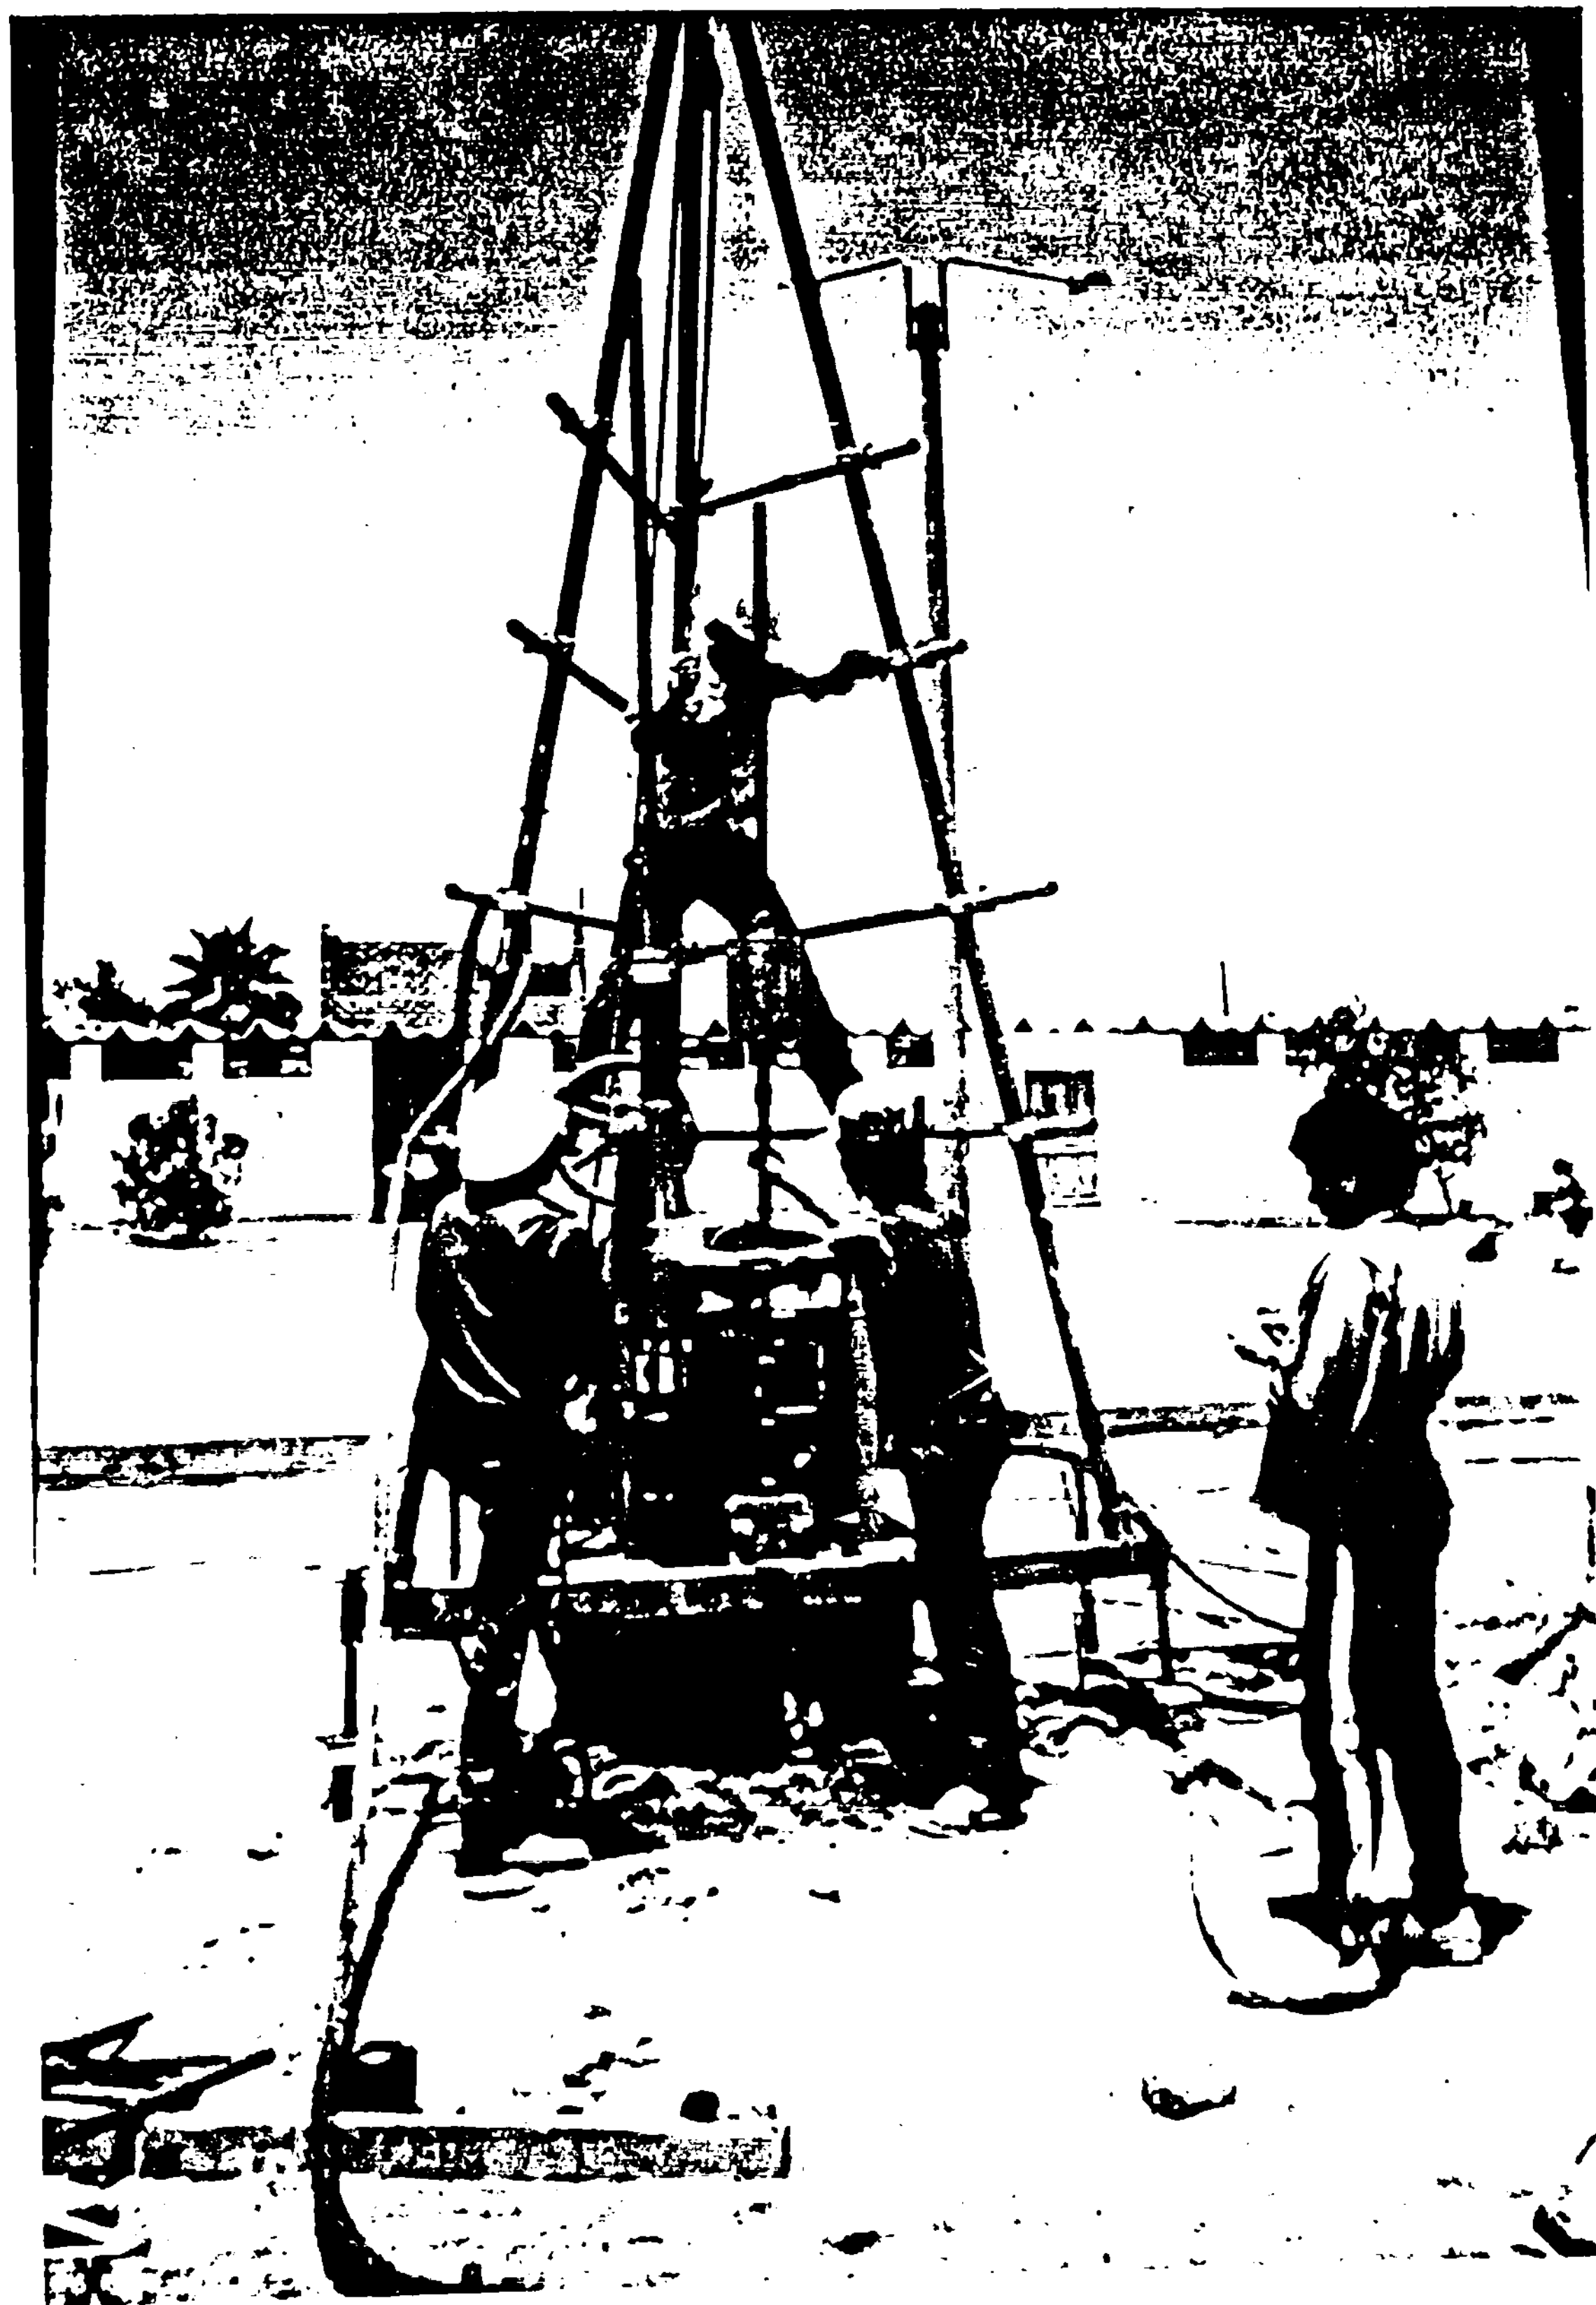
Sondaje S-6. Colegio La Libertad. La Libertad.
